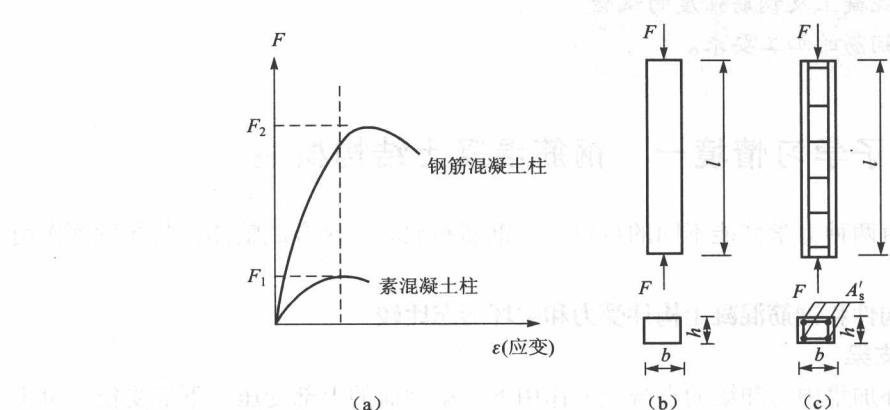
素混凝土和钢筋混凝土轴心受压构件的受力性能比较
